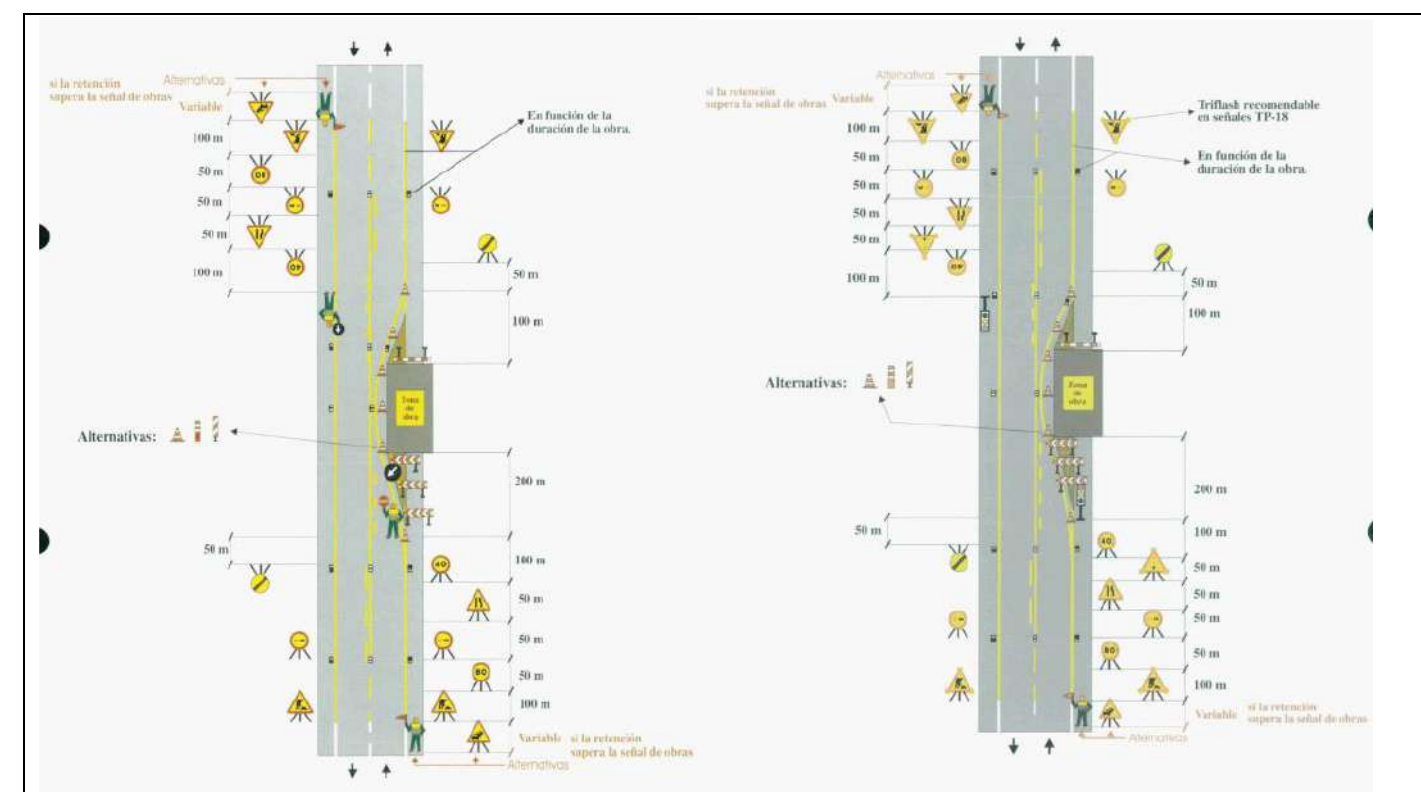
A) Treballs en voravia i carril amb pas alternatiu B) Treballs en voravia i carril pas alternatiu (NIT)
